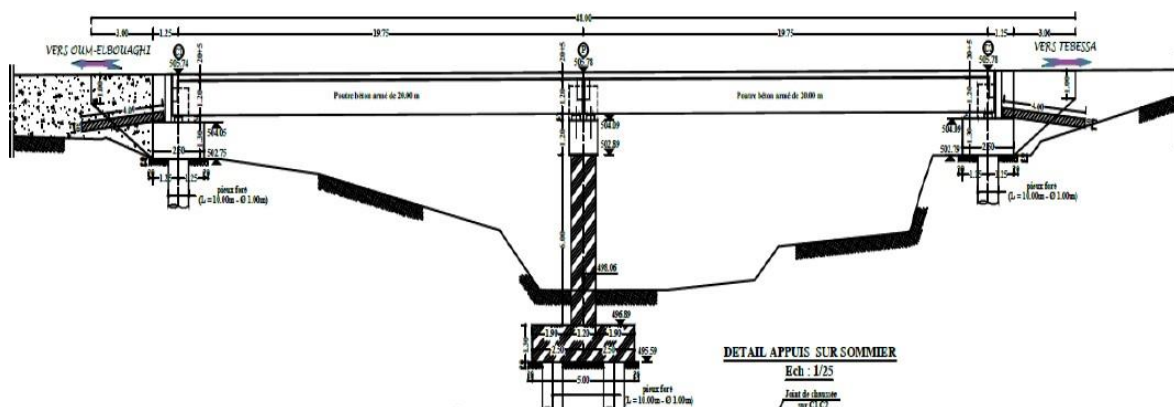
Coupe longitudinale du pont sur Oued Hamadja
